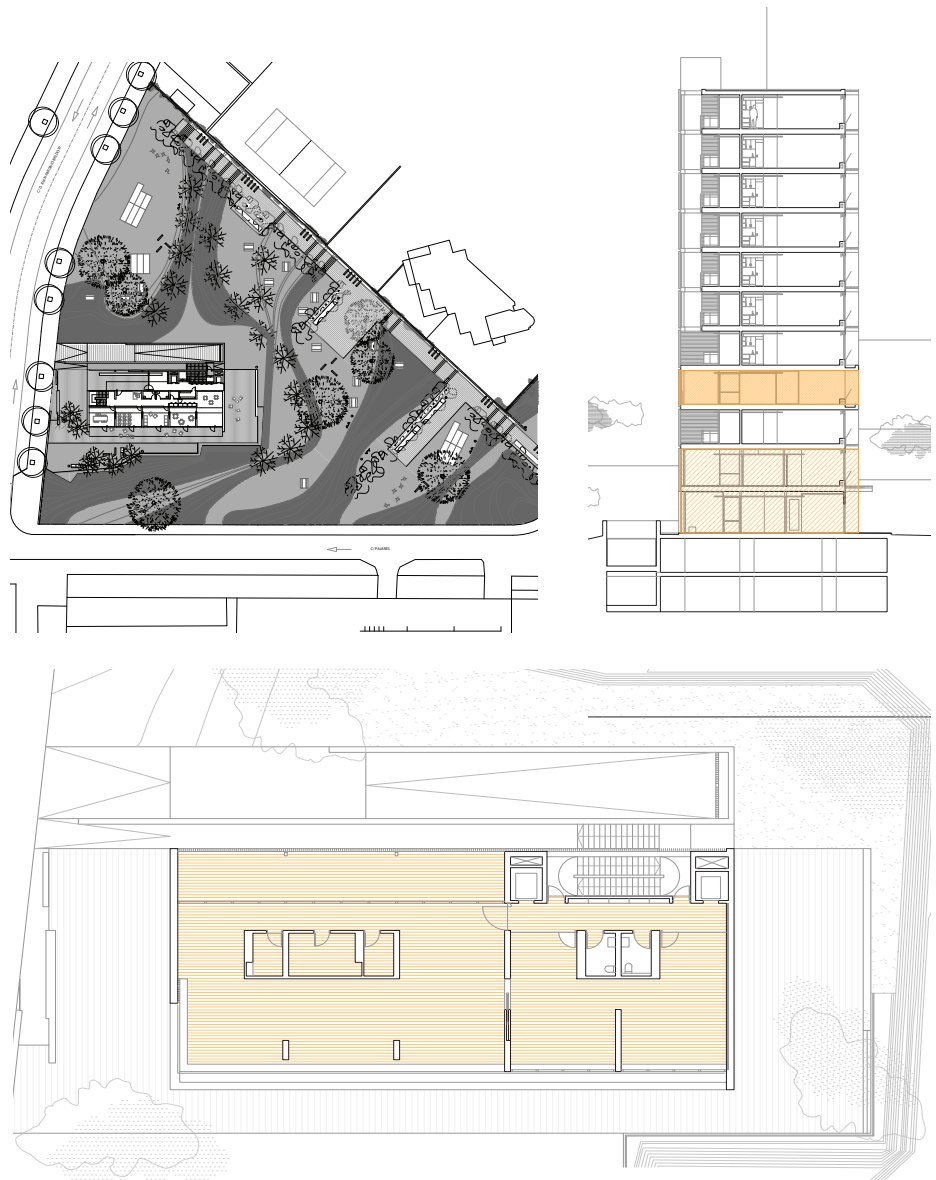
Planta de situación de las viviendas para mayores en Benidorm. (2005-2008)
